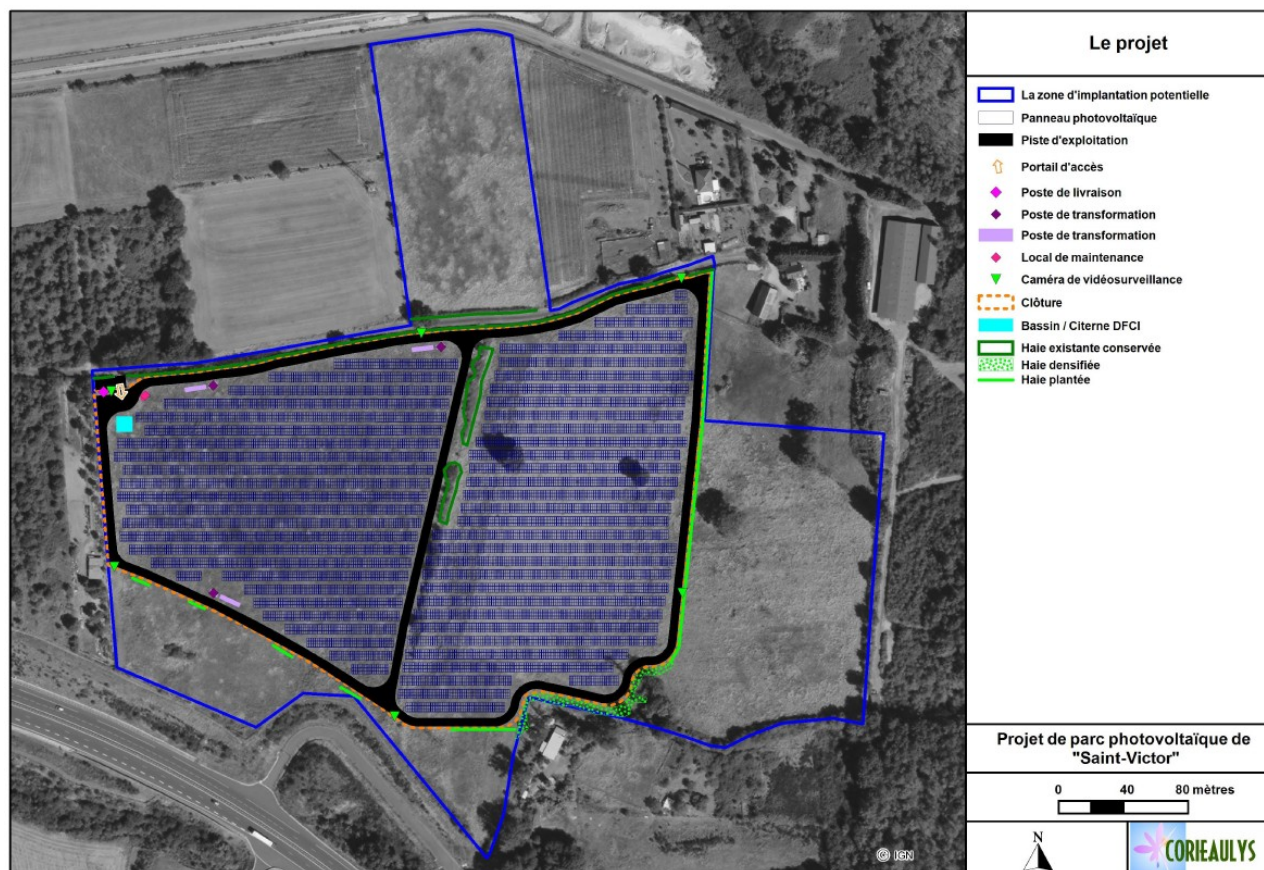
Plan d'implantation du projet (source : étude d'impact)
